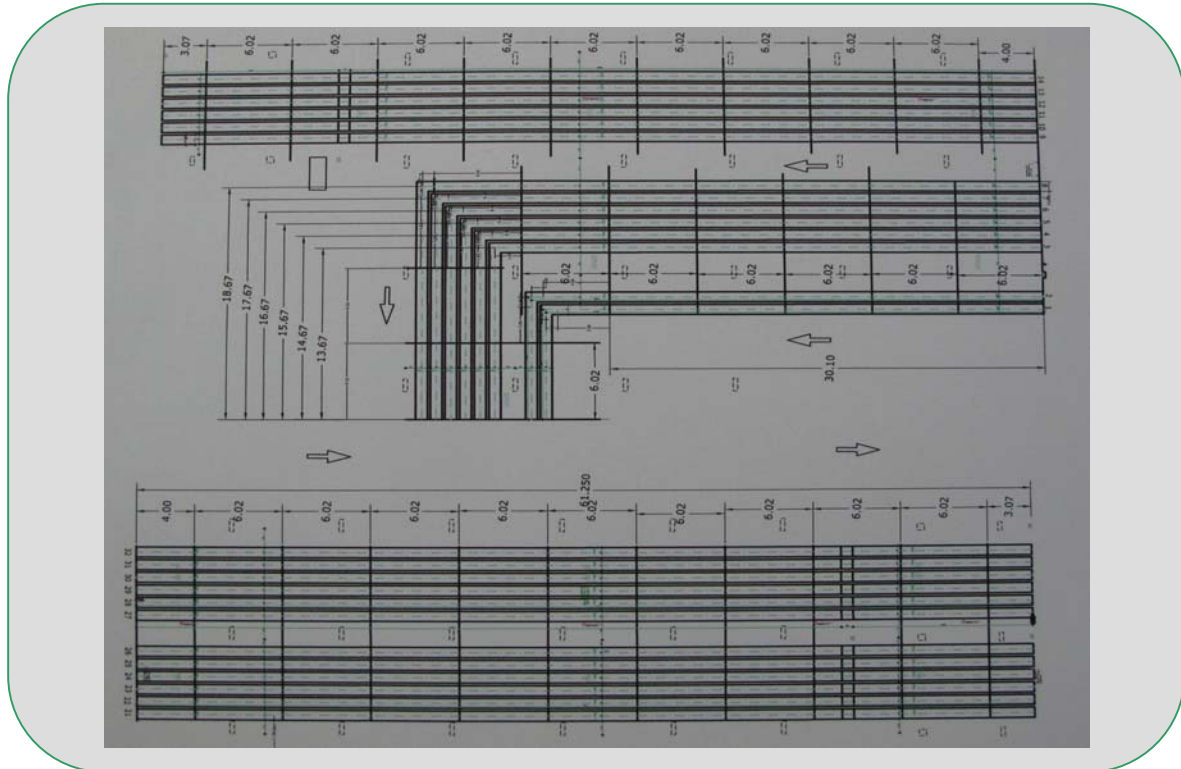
Grundrisse der Lüftungsleitungen DN 800 innerhalb der Bodenplatte
